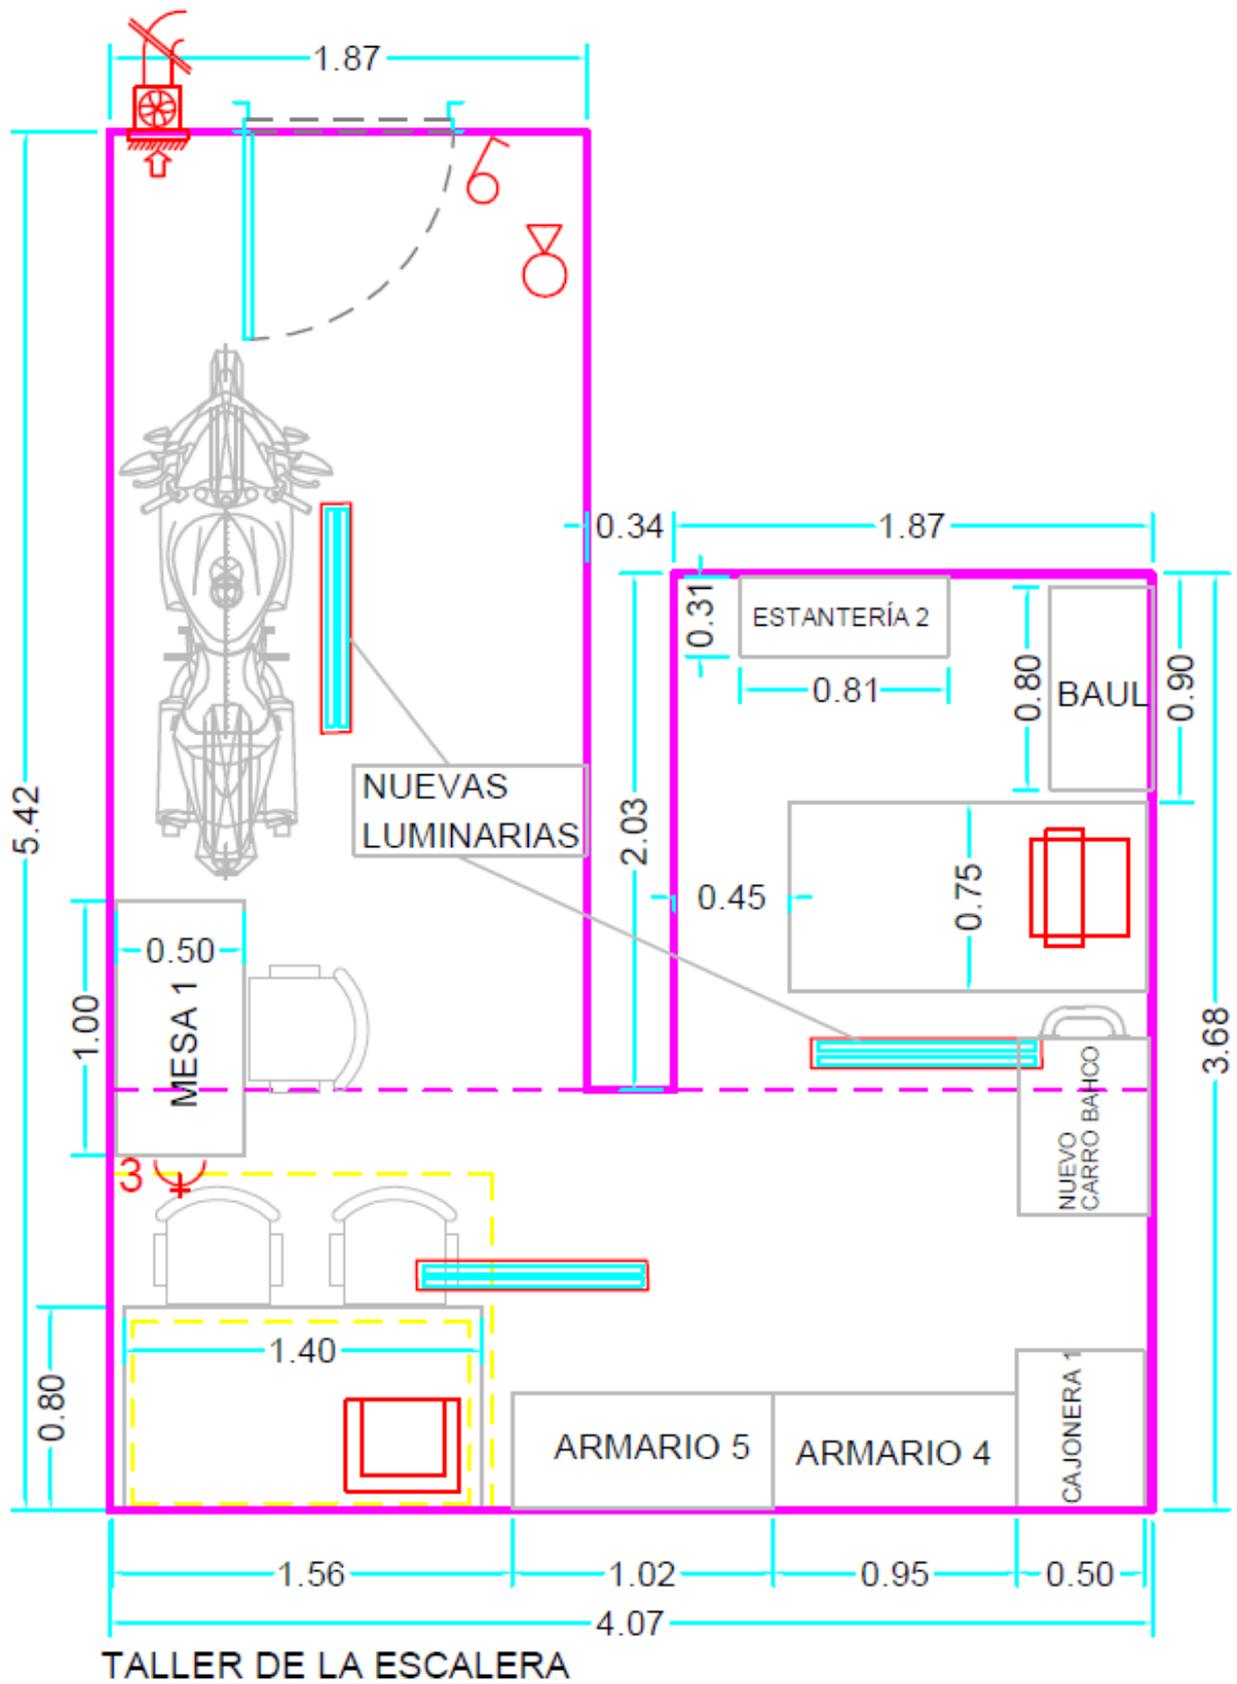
Planta del taller de la escalera en su estado reformado.
